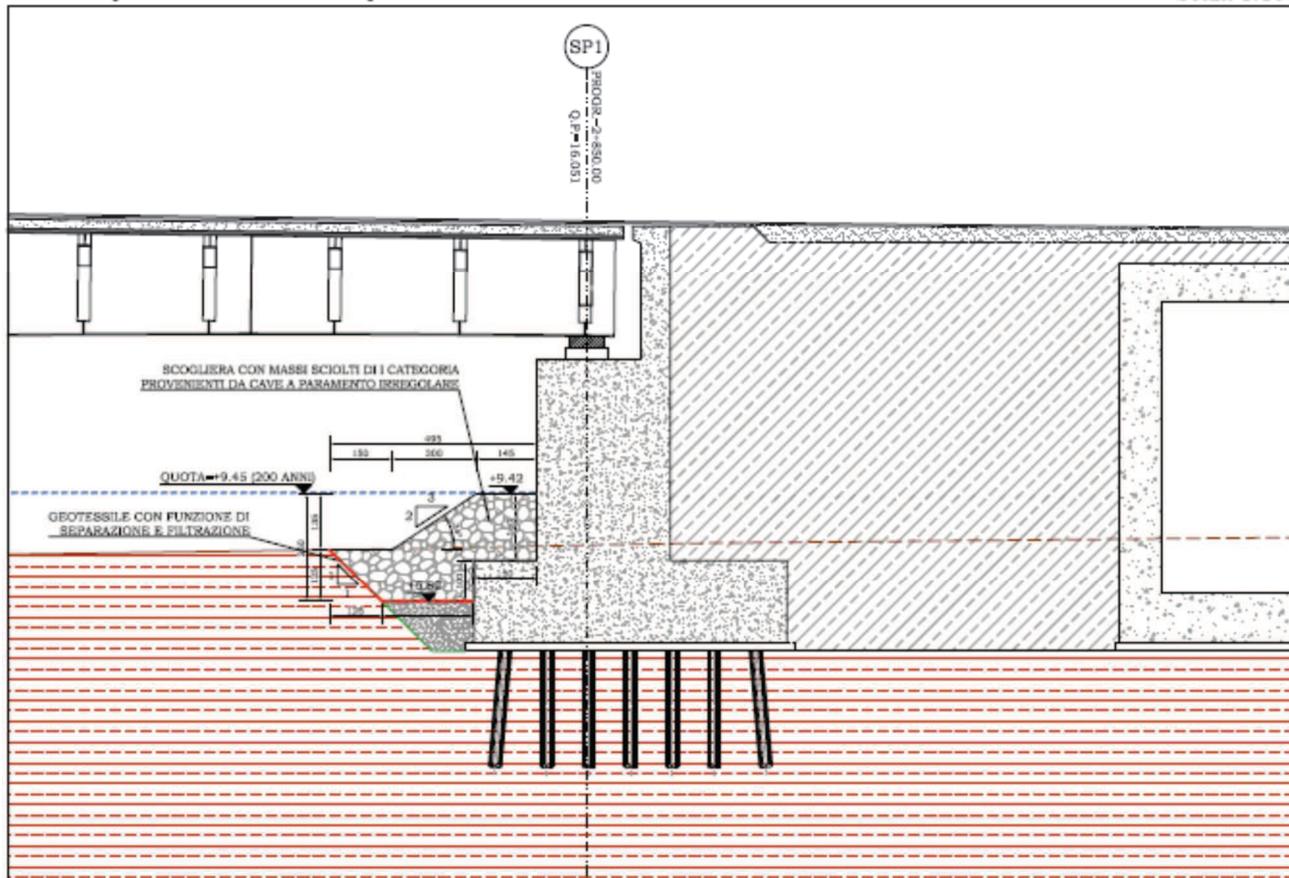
Protezioni della spalla 1 del Viadotto Calvia 1
